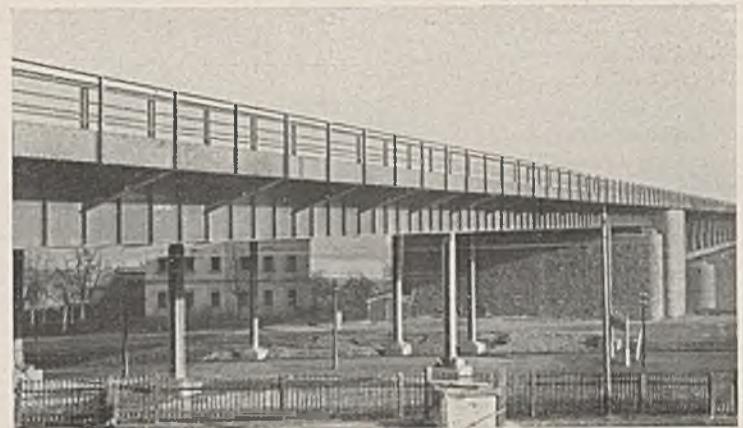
Elbebrücke bei Dresden. Anschlußbrücke.
